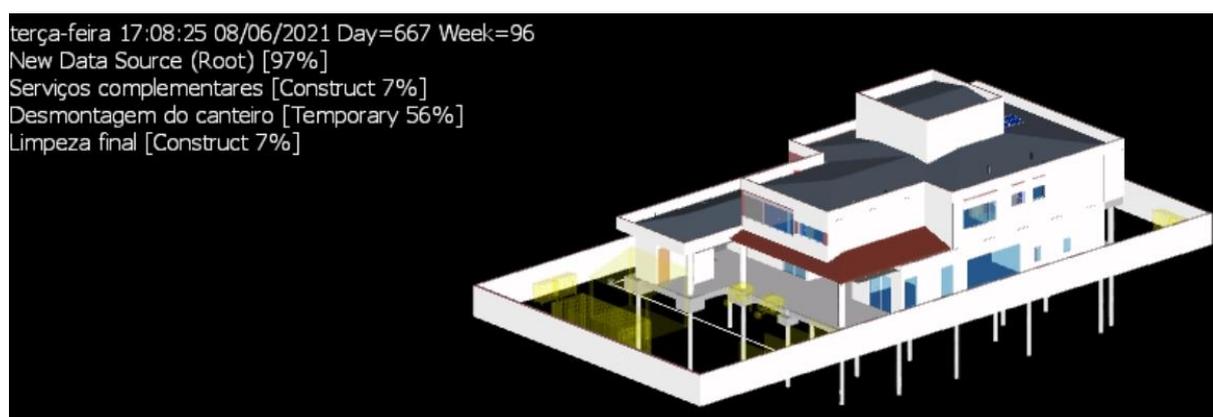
Desmontagem do Canteiro e Limpeza Final (Pintura finalizada)
